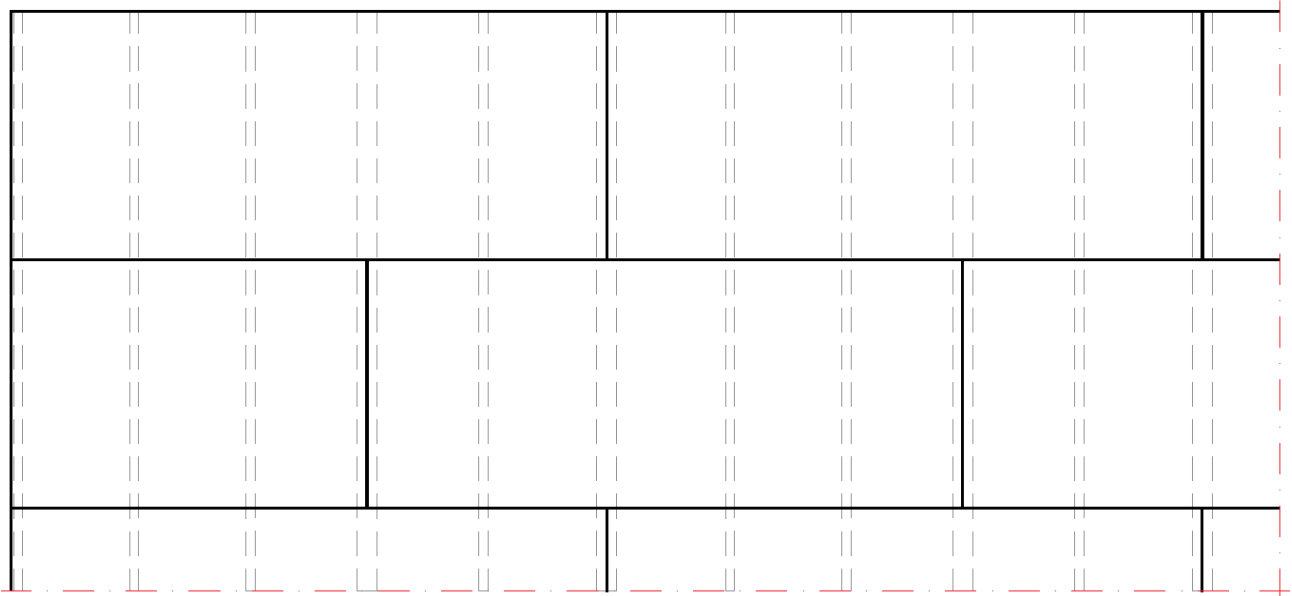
Disposição dos painéis, apoiados sobre vigas
